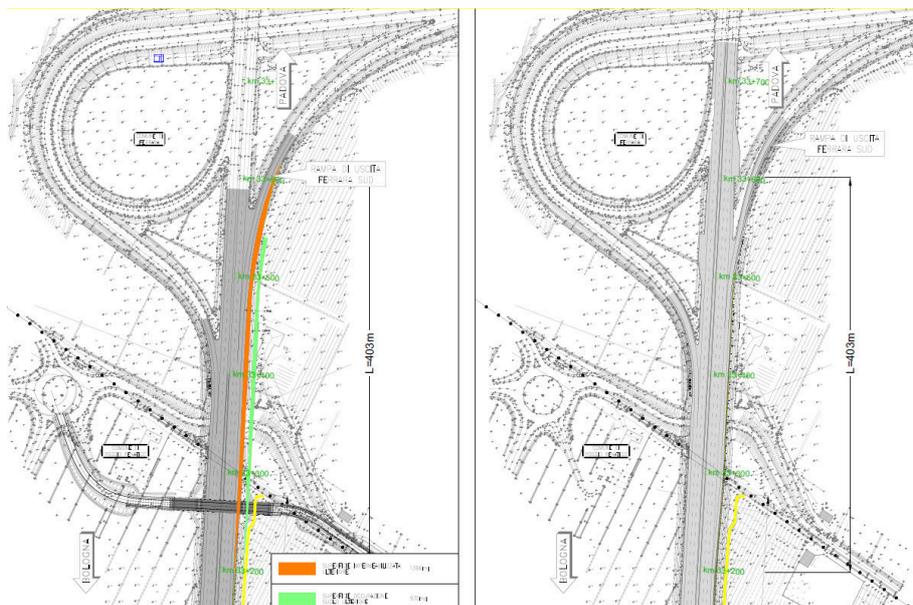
confronto tra progetto in valutazione preliminare (v. planimetria sx) e progetto presentato in Conferenza di Servizi (v. planimetria dx). Fonte: Allegato 2 alla Lista di controllo
